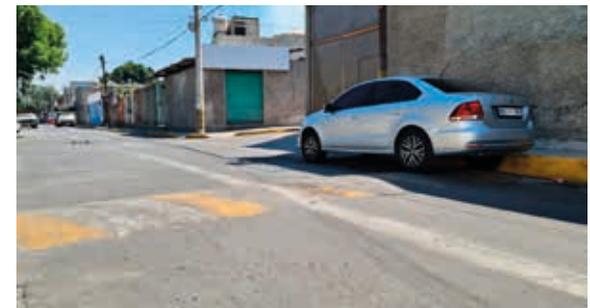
Mitigación de grietas en calle Lucio Blanco
